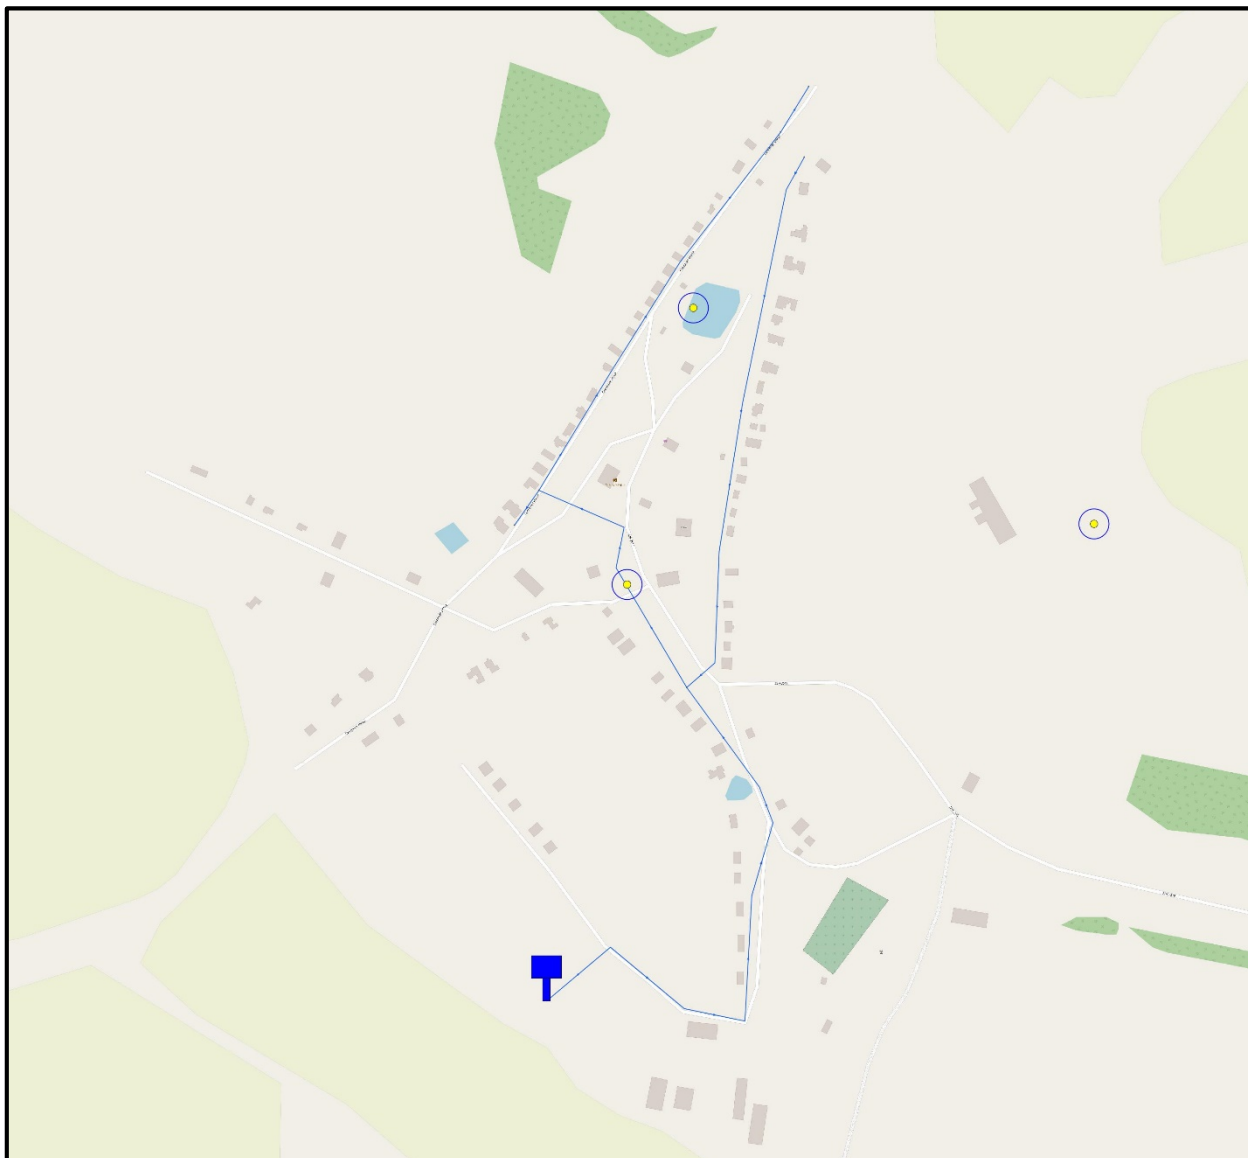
Схема водоснабжения с. Александрово
